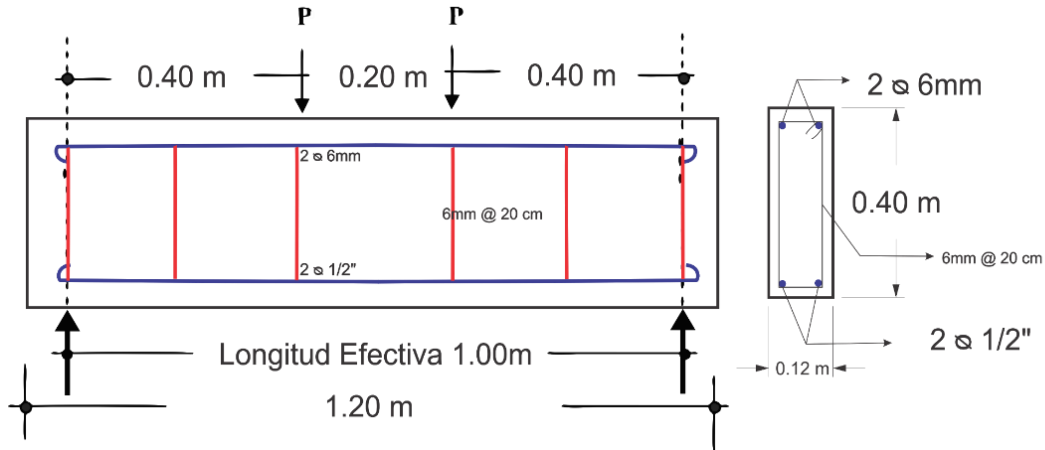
Detalle de la viga de gran altura del modelo 02 con refuerzo a corte
